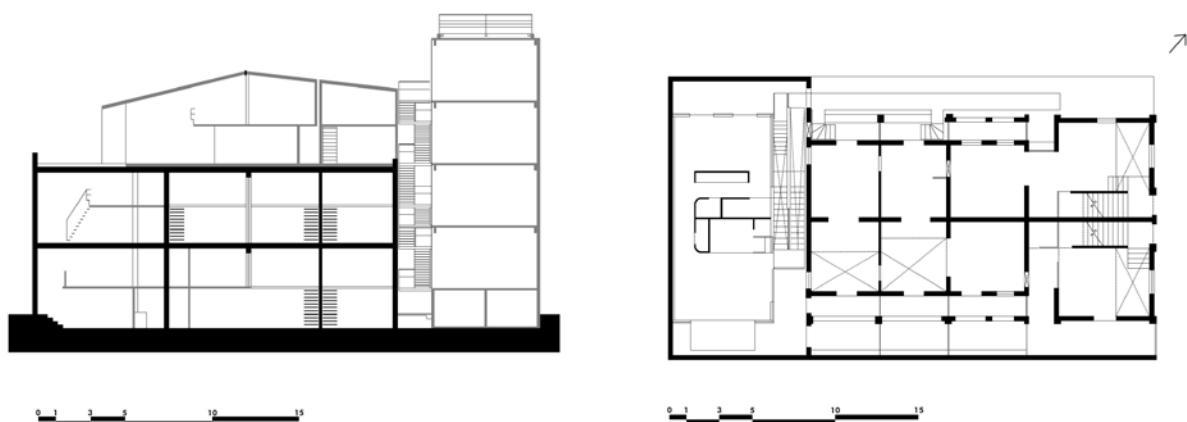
Plano arquitectónico de Havre 69, se puede observar la planta y corte del antiguo edificio en el que hubo cuatro viviendas y que ahora ofrece 12 y un comercio. El proyecto de reutilización se desarrolló sobre la construcción original, así como de su azotea y el patio posterior. Fuente: Dibujo de Diana Ortiz.
